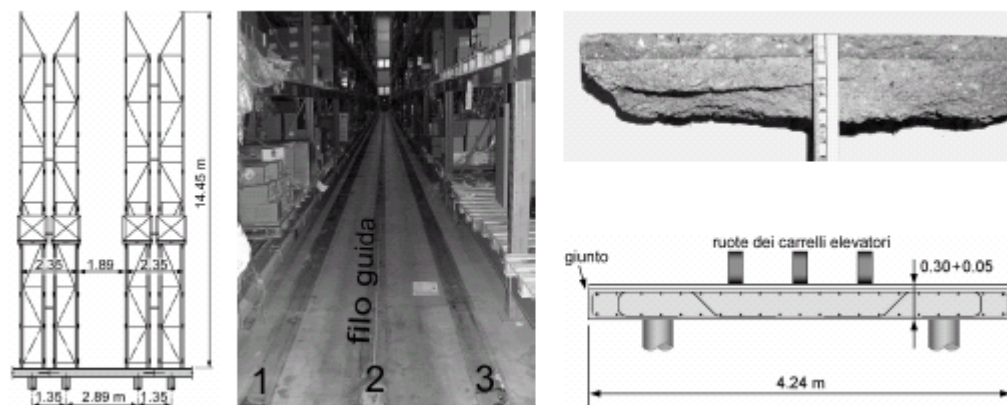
Caratteristiche della pavimentazione indagata: sezione tipo delle scaffalature e vista di una corsia di accesso con le impronte delle tre ruote dei carrelli elevatori e il filo guida, sezione della piastra di pavimentazione posata su pali e campione del sovrastante massetto con lo strato resistente all'usura.
